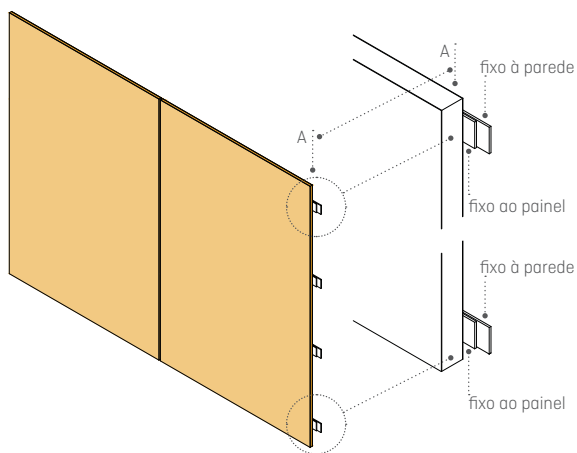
Detalhe construtivo para aplicação de painéis com velcro
